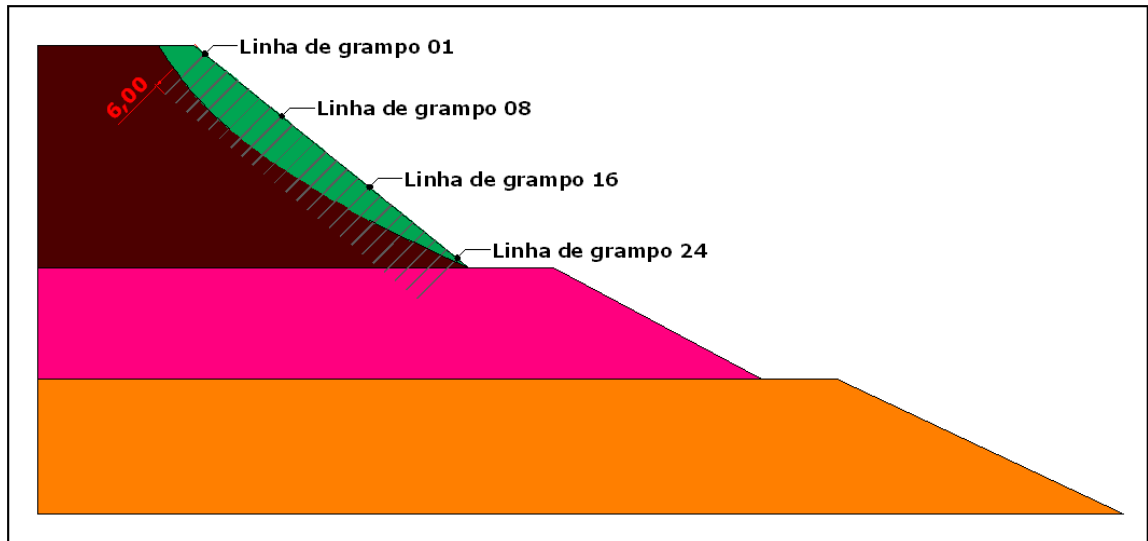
Esboço da seção longitudinal – disposição dos grampos
